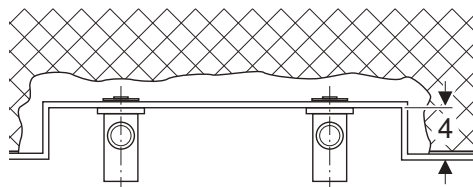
Dimensões de instalação para montagem interior com deslocamento da placa de montagem Geberit
